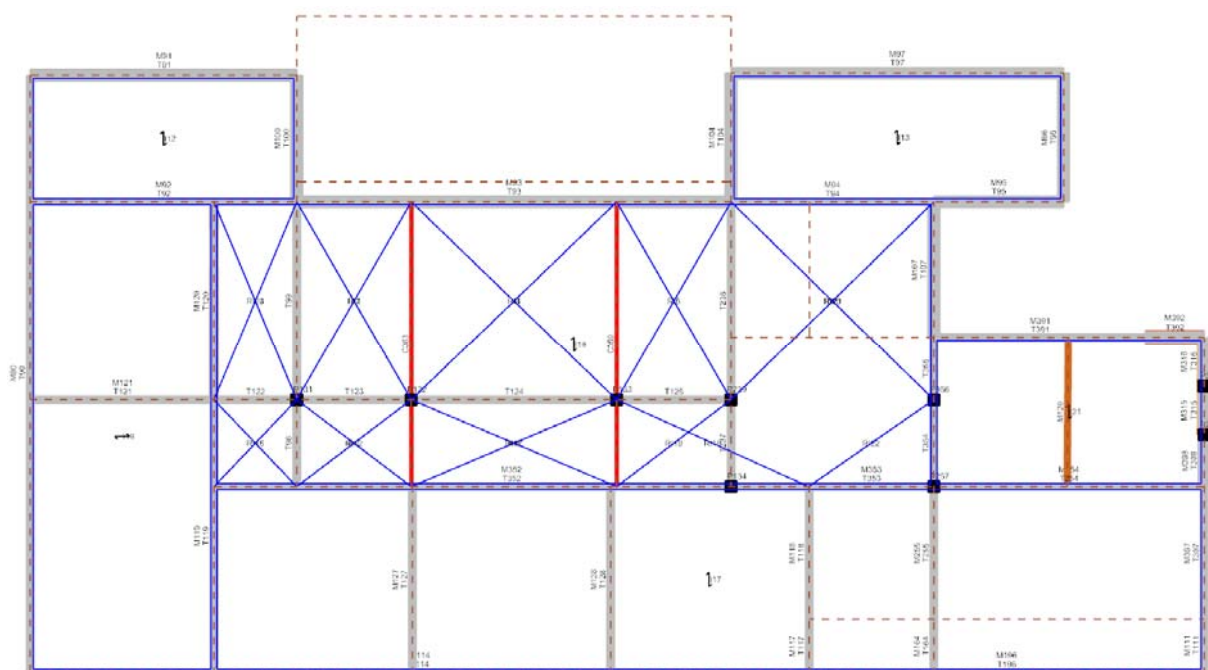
pianta livello 2 con numerazione maschi murari, pilastri, travi e solai.
